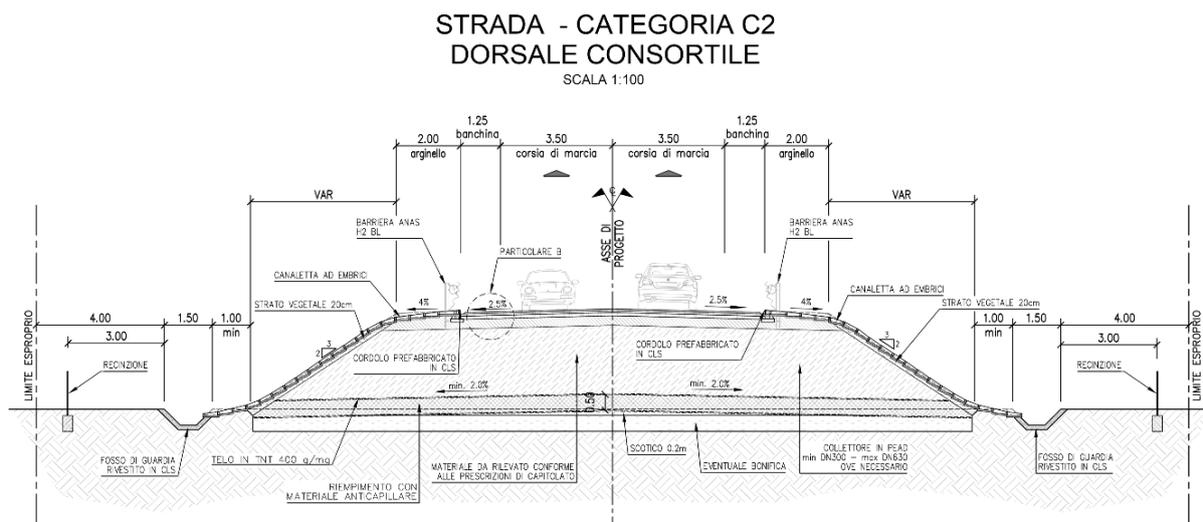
Sezione tipo in rilevato dell'asse secondario - Complanare Casic "Dorsale Consortile"
